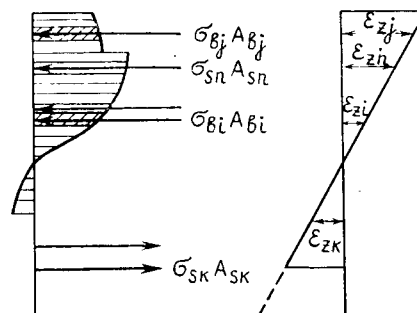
Расчетная схема нормального сечения элемента с косвенным армированием
